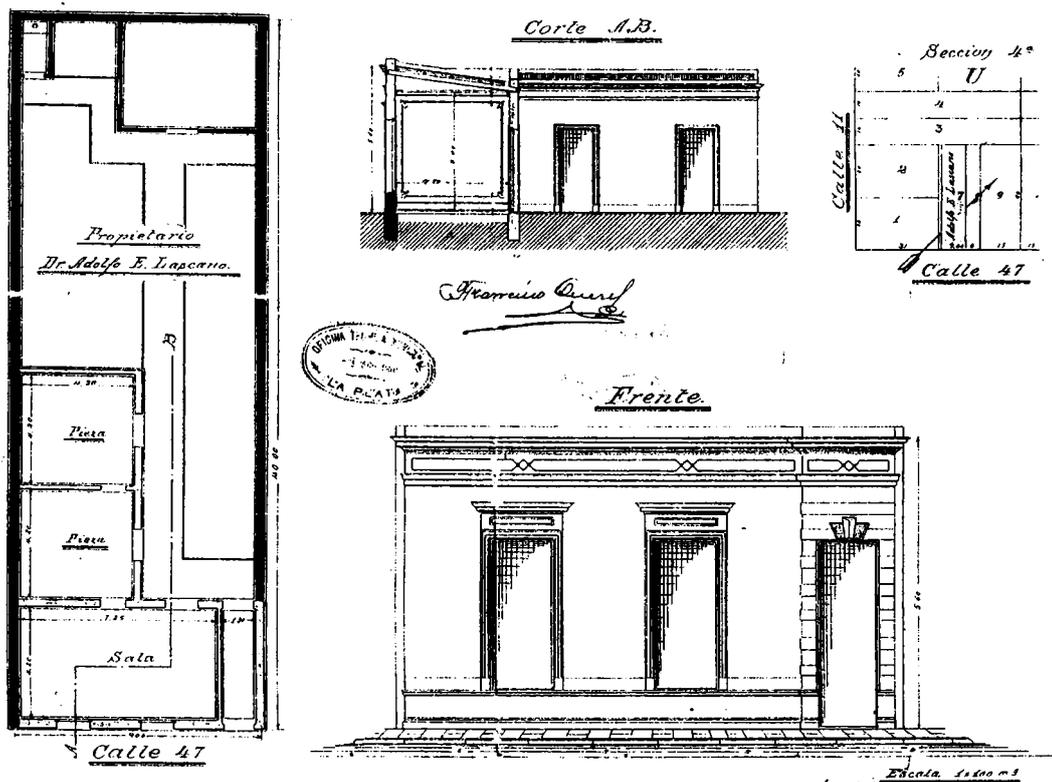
Casa de alquiler del Intendente Adolfo Lascano. Calle 47 entre 10 y 11, La Plata. Planta, corte y vista. Año 1901.
